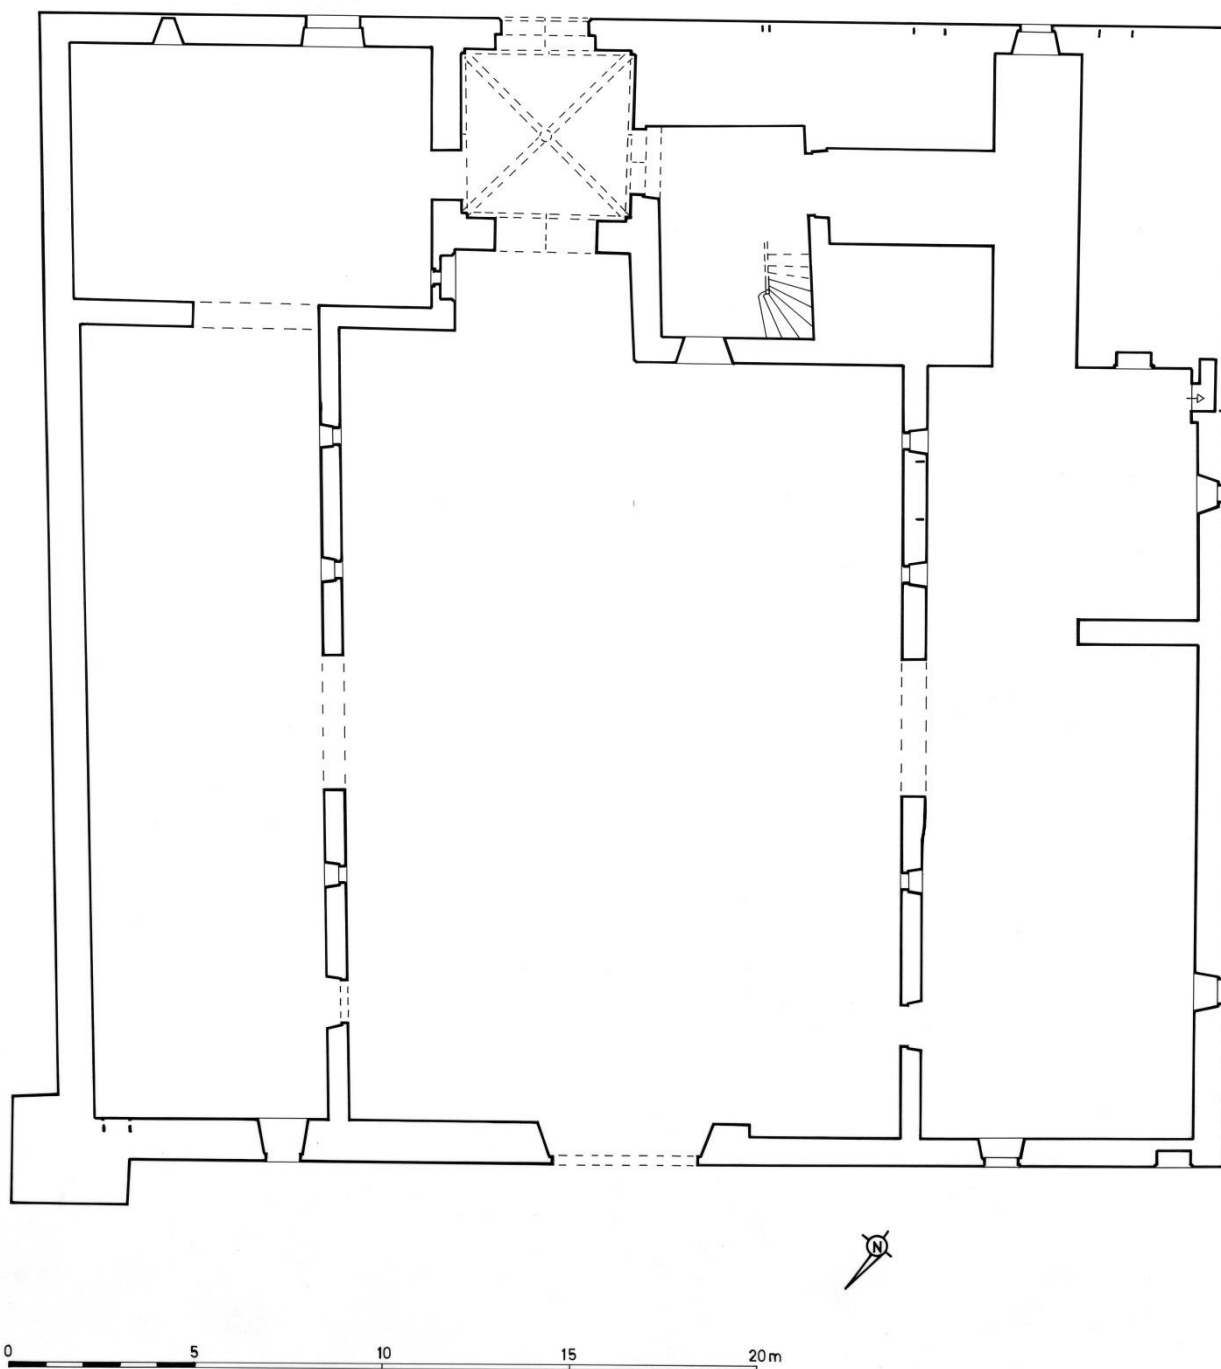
Relevé du plan du château par Patrick Roques (1997) : rez-de-chaussée.
